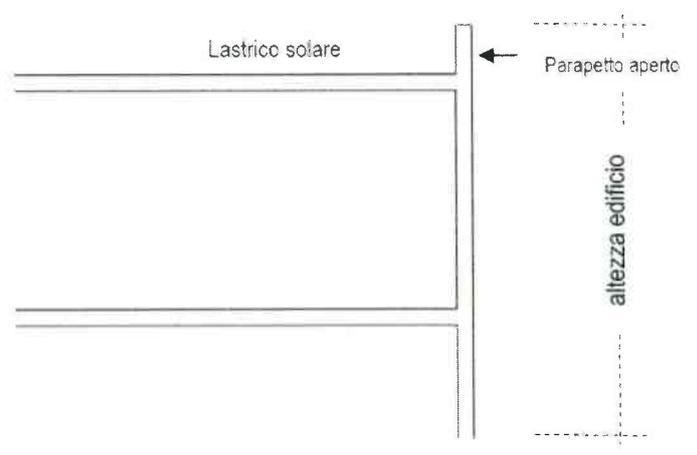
Edificio con copertura piana parapetto aperto e lastrico solare o terrazza.
